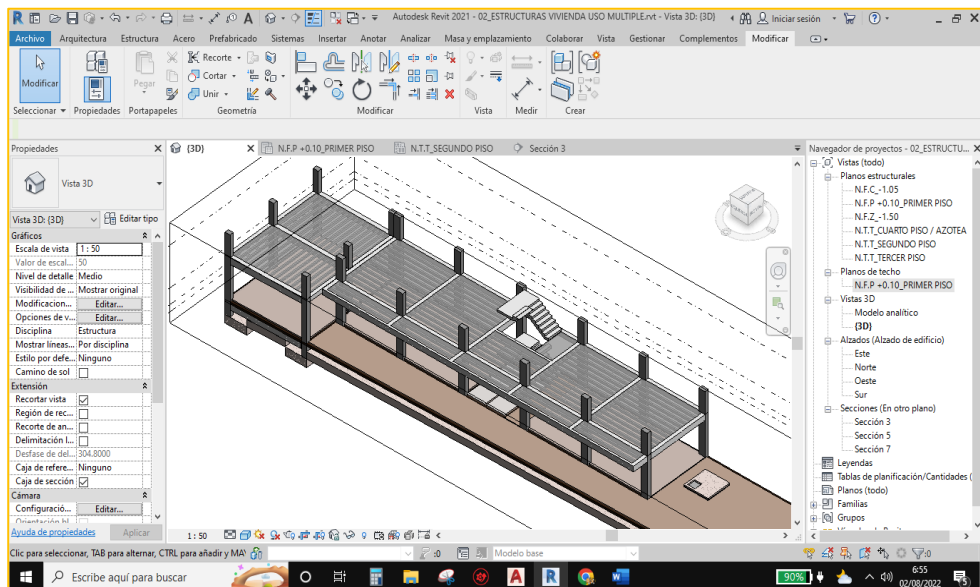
Vista 3D de la ubicación en primer nivel de las viguetas.
